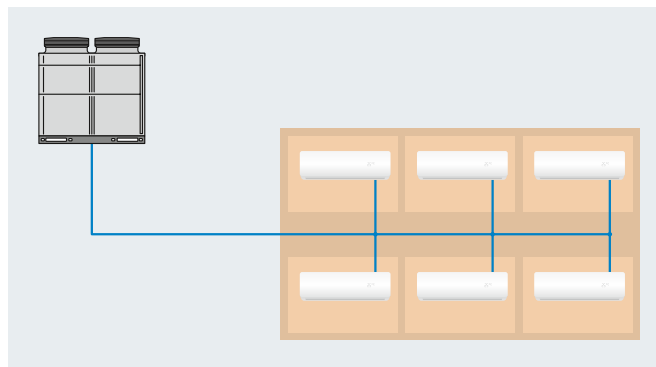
Смешанная схема обвязки внутренних блоков трубопроводами (рекомендуемая)
